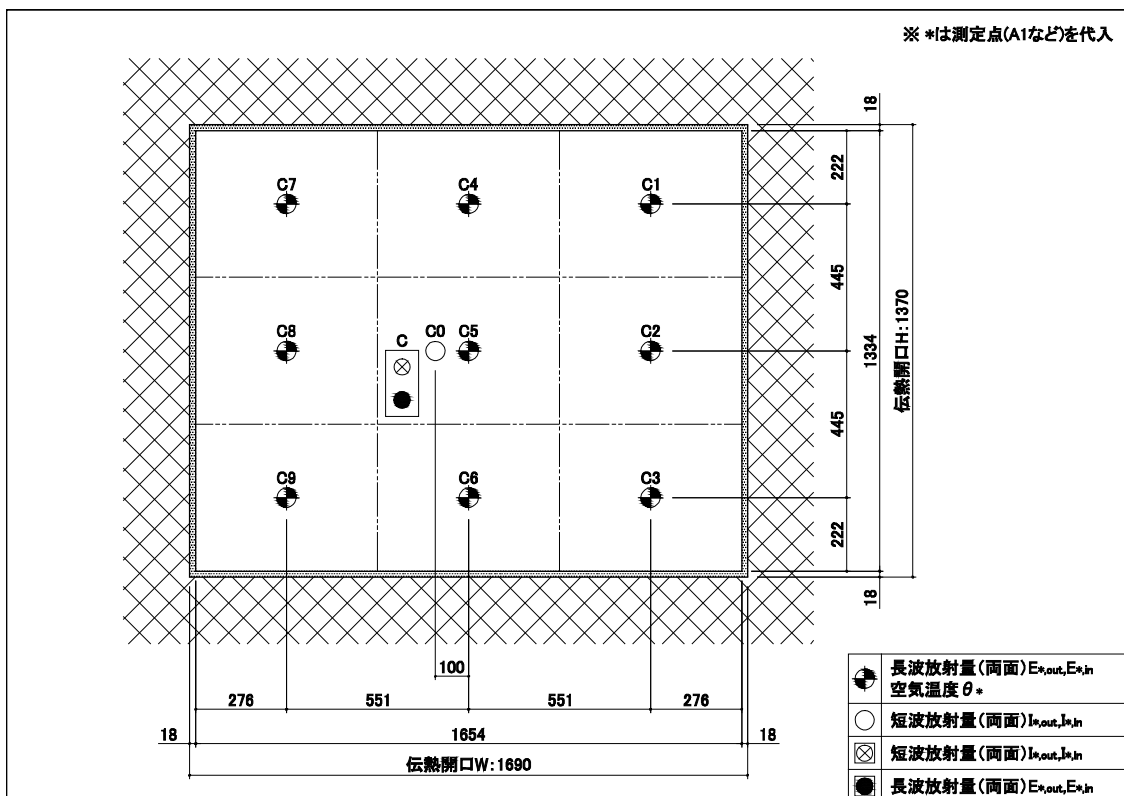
センサー配置図 (室内, Section C, ※内観を示す)
